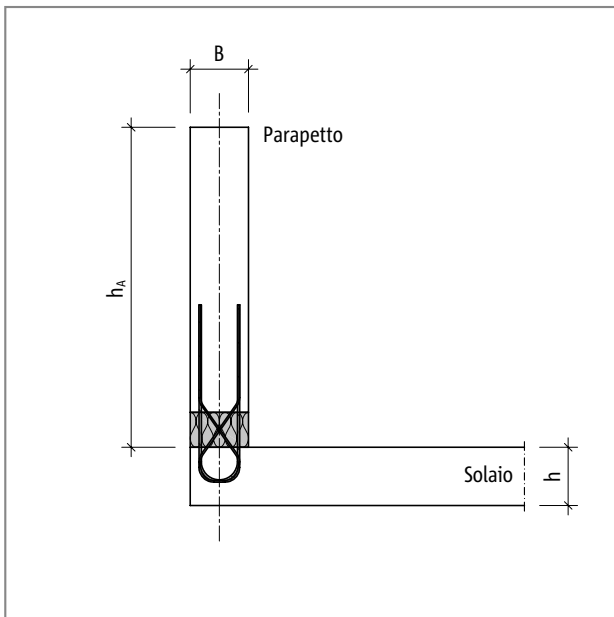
Schöck Isokorb® tipo ABXT, schema statico con altezza del parapetto  $h_A$
